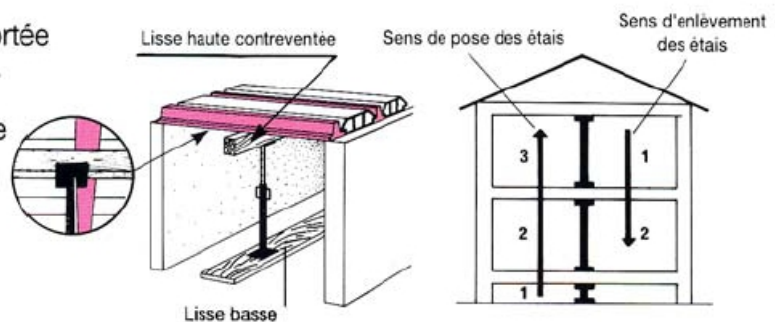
Mise en œuvre des planchers avec poutrelles préfabriquées 2
